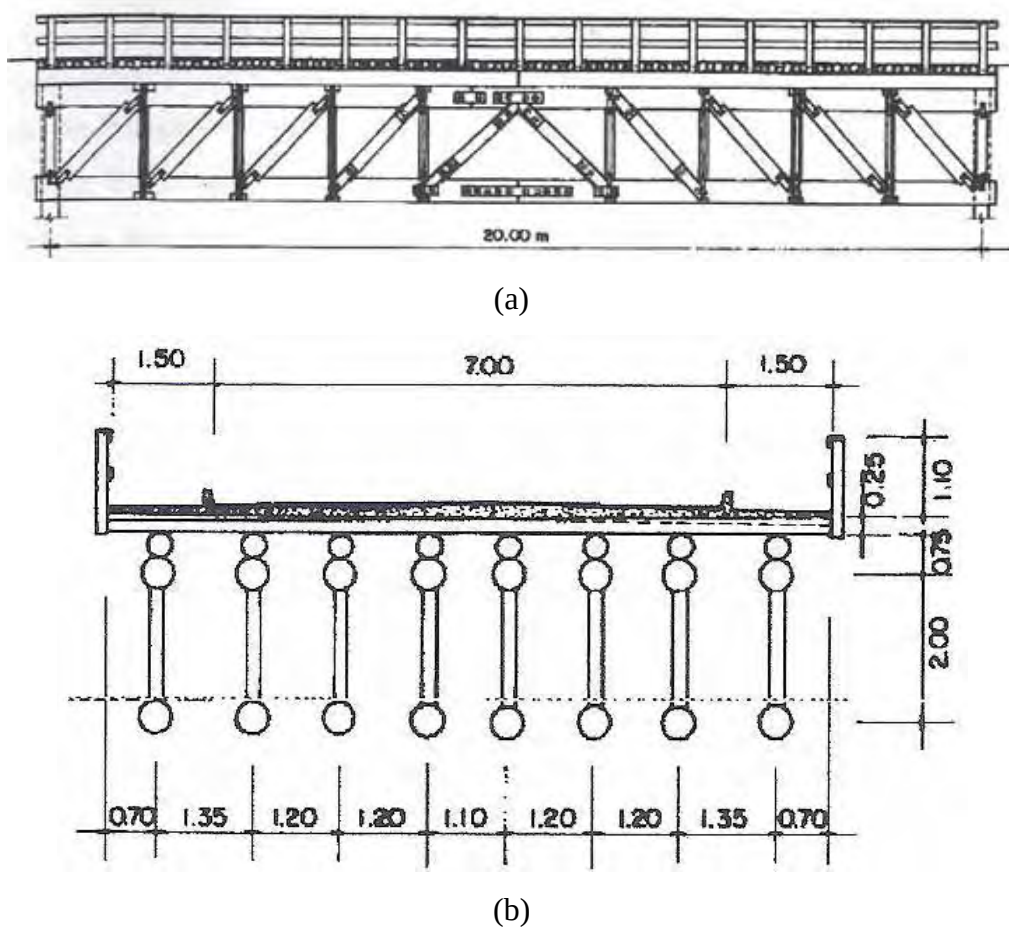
Ponte em viga treliçada, em (a) Vista lateral e (b) Corte transversal.
